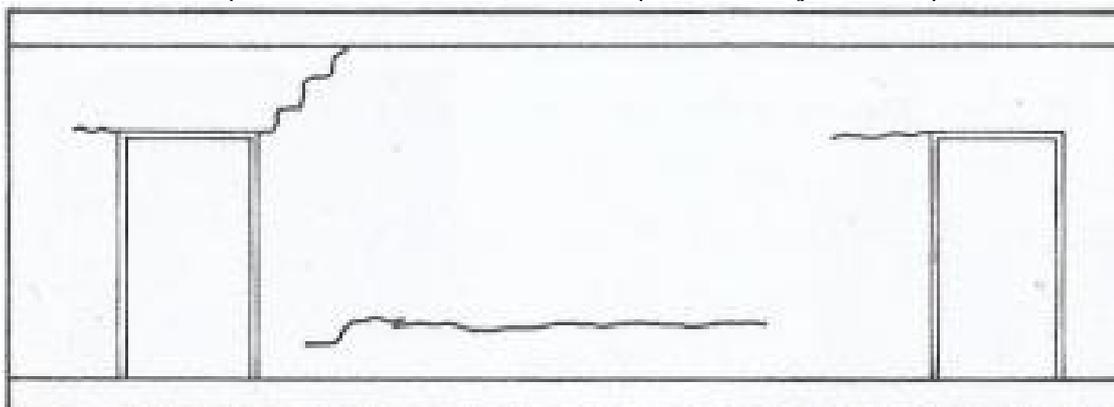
Fissuração típica nos cantos das aberturas em paredes sob atuação de sobrecargas
